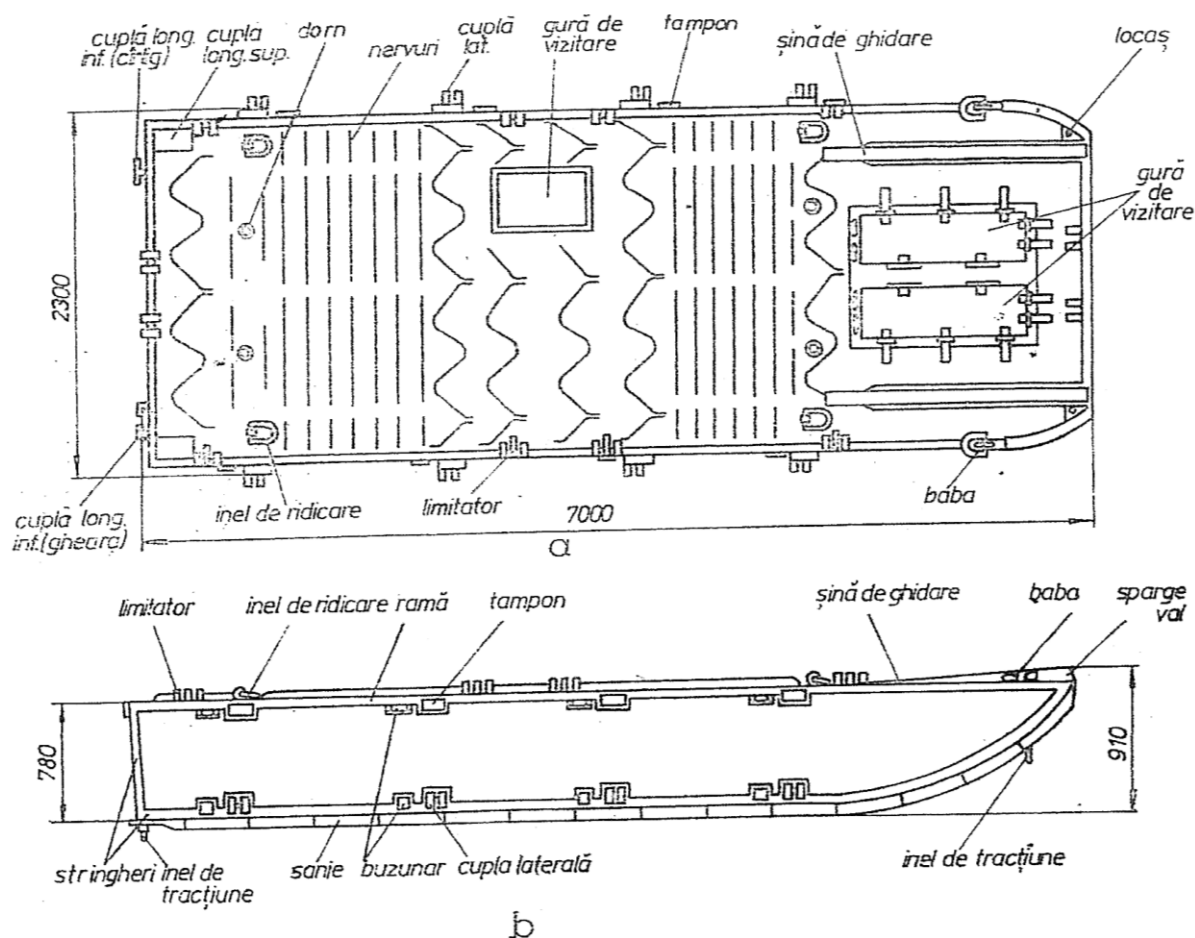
Ponton. a-vedere în plan ; b- vedere laterală
